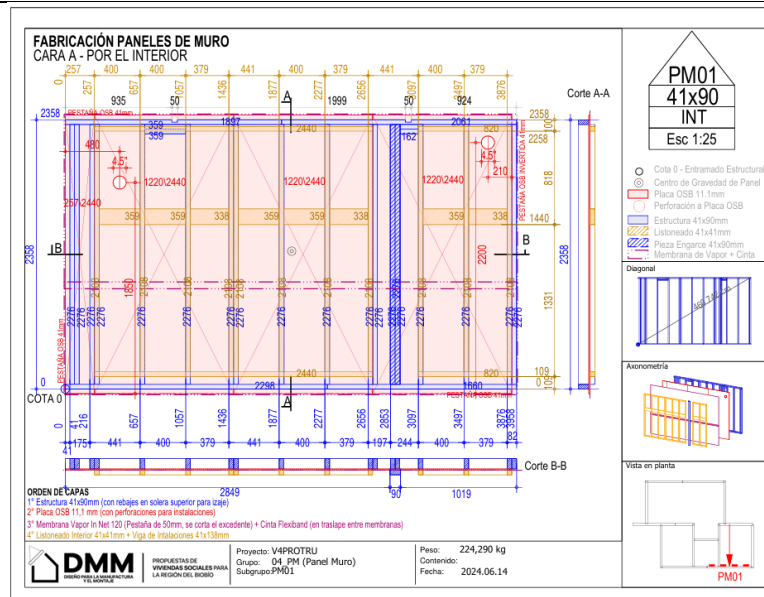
Plano de Manufactura, Ejemplo Panel de Muro.
